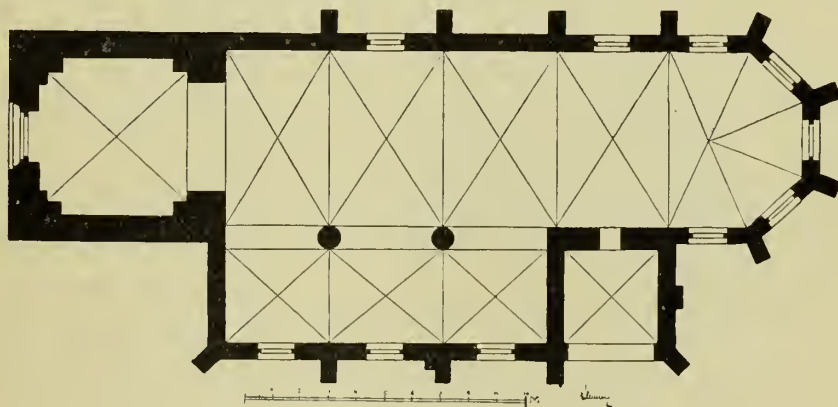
Schermbeck. Grundriss der evangel. Pfarrkirche.
